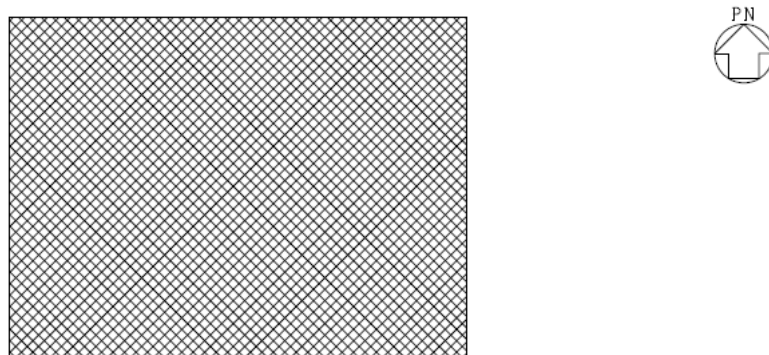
(8) 原子炉建物原子炉棟 (二次格納施設) の範囲の平面図
